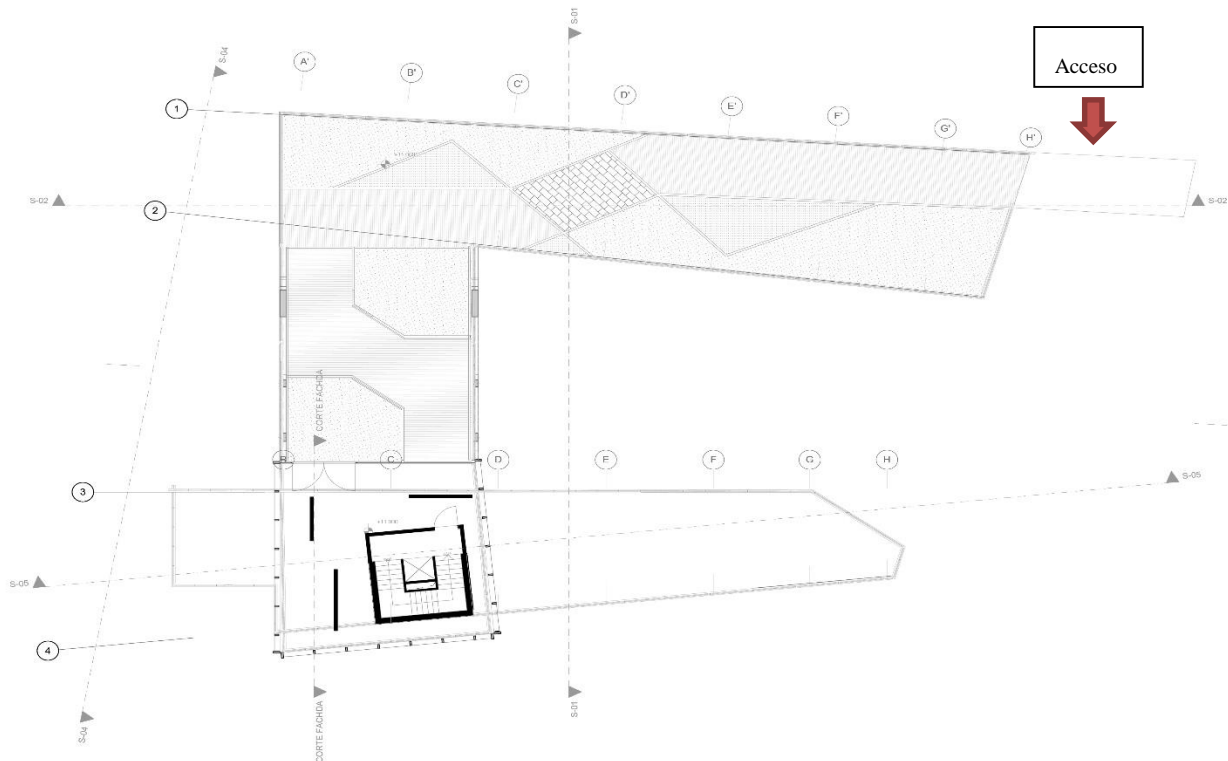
Planta de cubiertas transitable y acceso desde la calle. Imagen del autor
